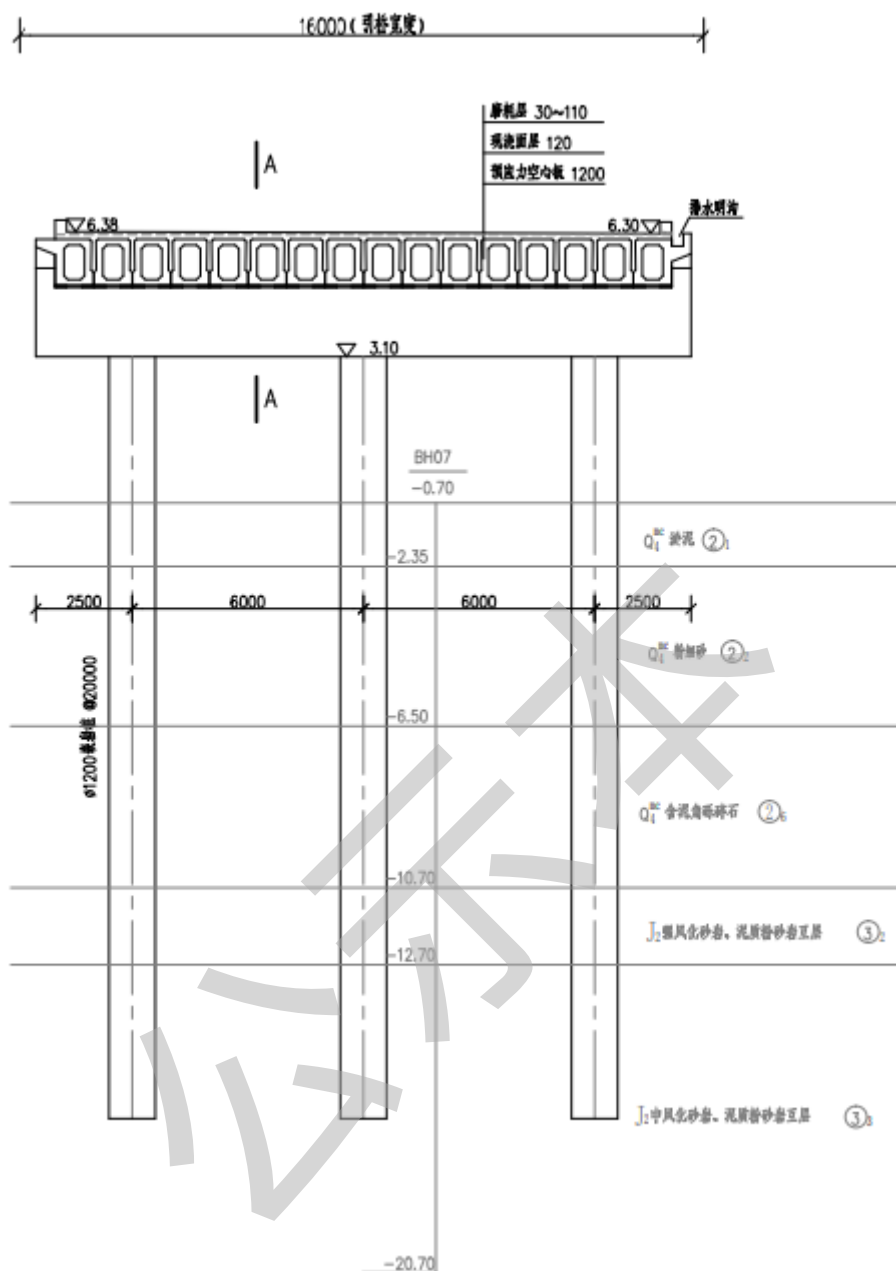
4 号引桥 (16m 宽) 结构断面图
